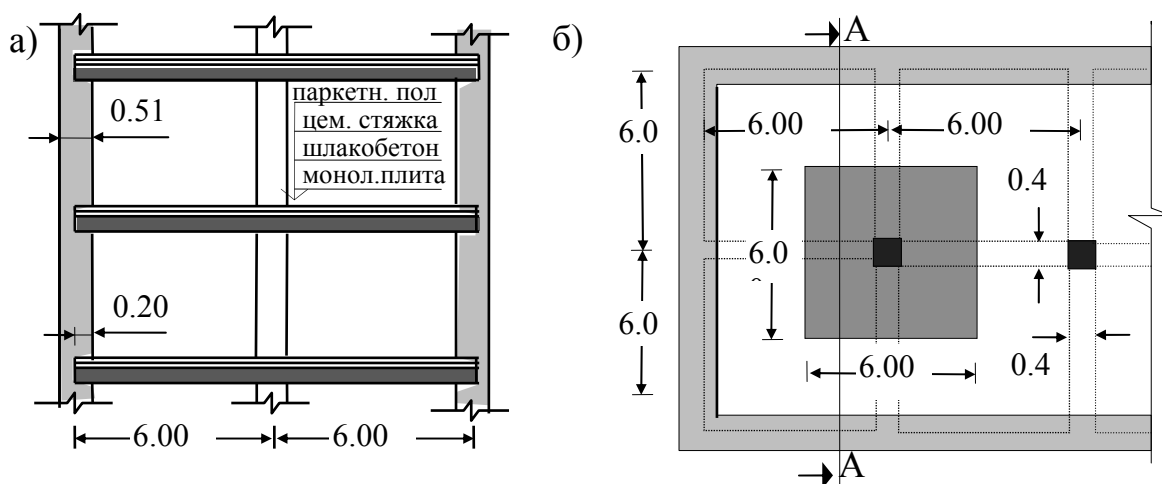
Ребристое перекрытие многоэтажного здания.
